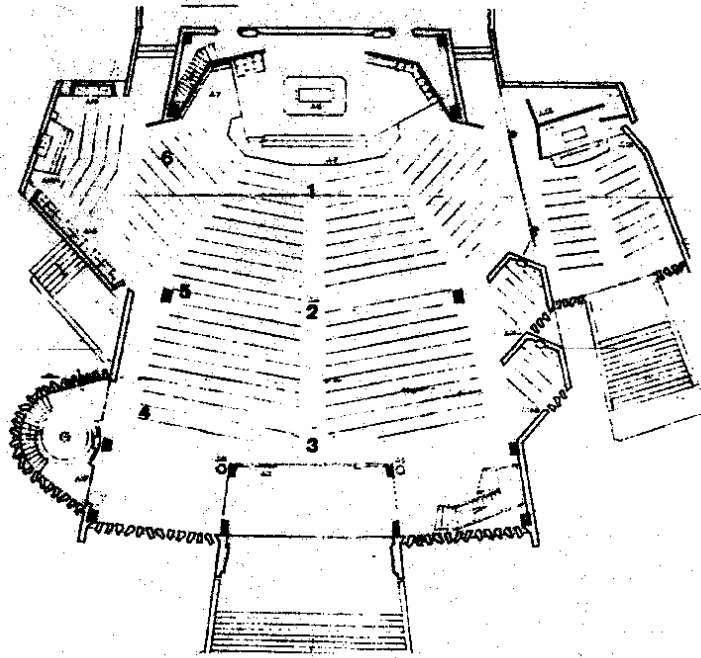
Planta da igreja de Cedofeita (Porto) [3]
